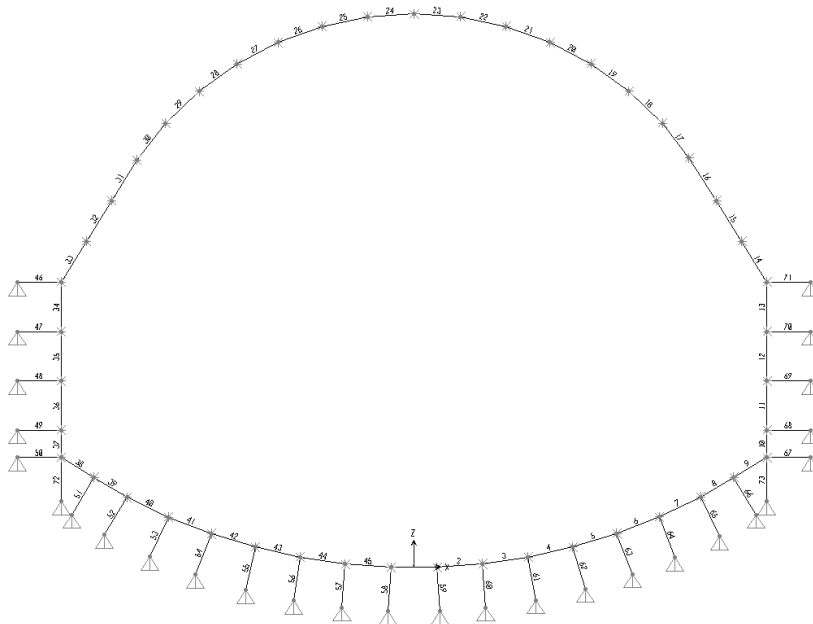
Discretizzazione per elementi finiti tipo "Beam": numerazione elementi strutturali
